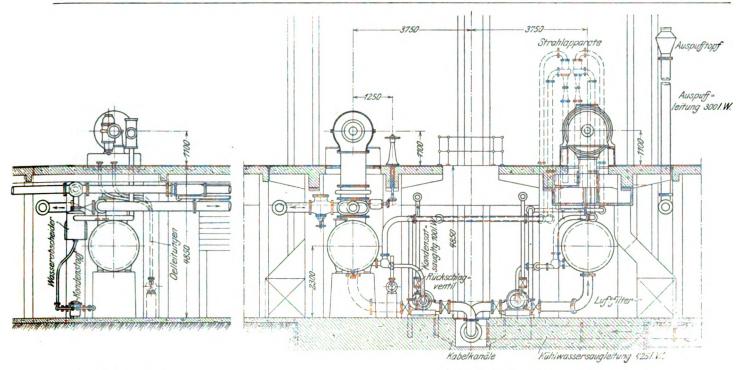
Kraftwerk Dörverden. Dispositionsplan zweier 1040 Kw Turbo-Generatoren mit Oberflächen-Kondensation. Bauart Brown-Boveri.
